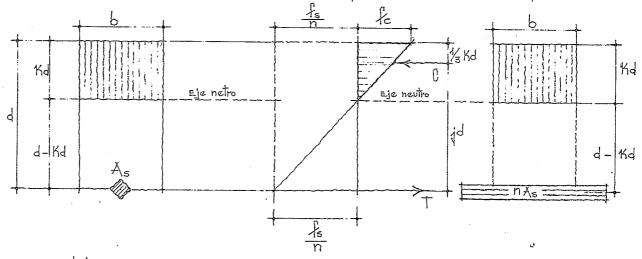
Corte transver sal de la viga. Fig. 3.7. Deformación de la viga. Espuezos. Fig. 3.8. Area trans formodo.
